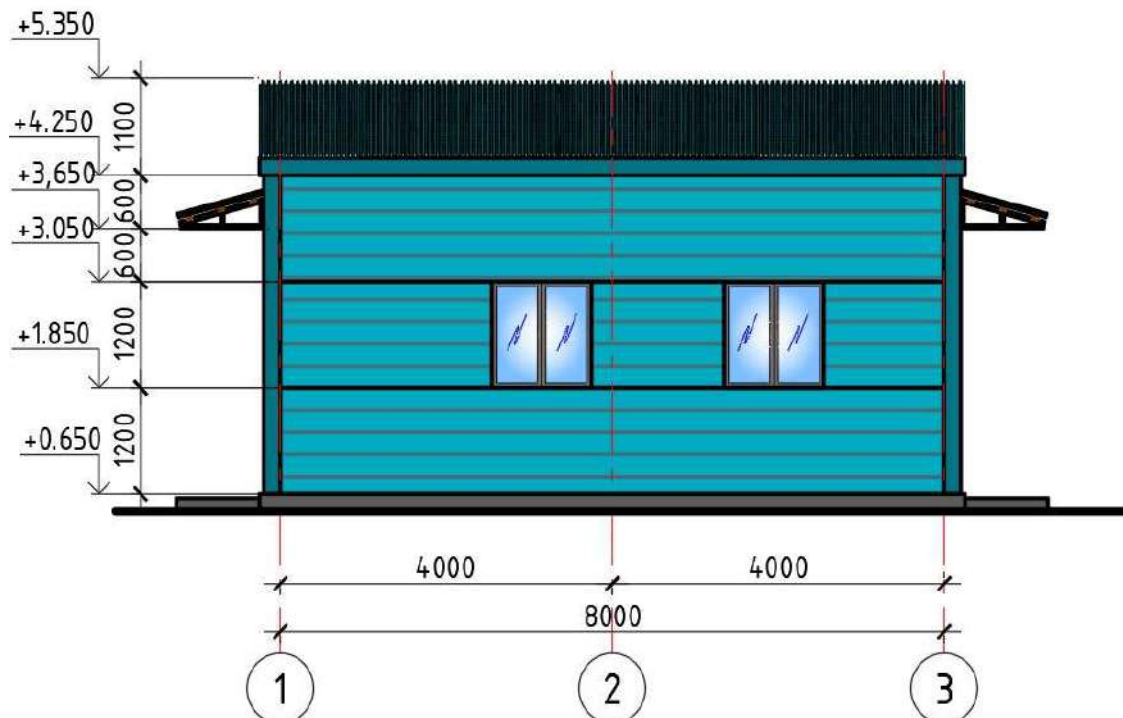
Фасад здания насосной откачки хвостовых растворов
